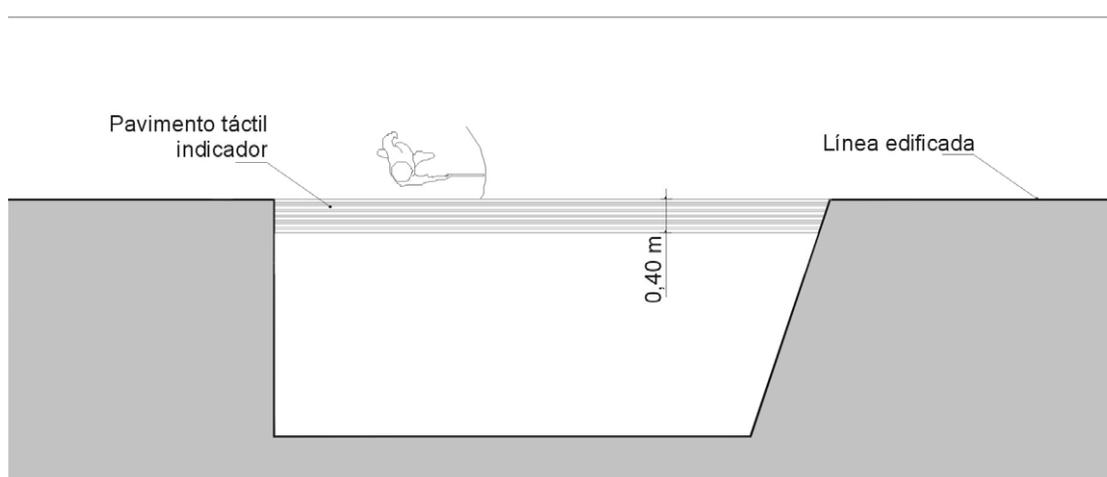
Franja de pavimento táctil indicador direccional que da continuidad a la línea edificada
